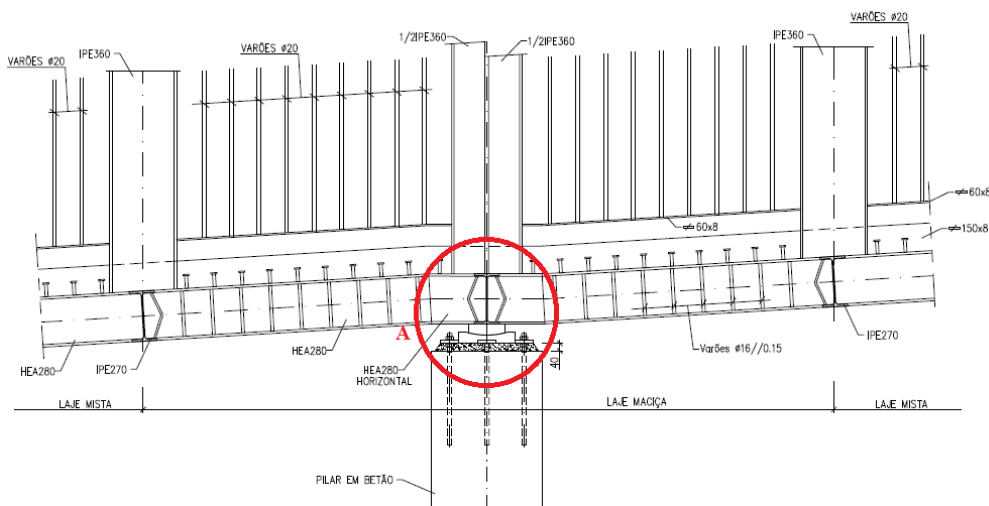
Corte longitudinal do tabuleiro na zona dos pilares [25].
